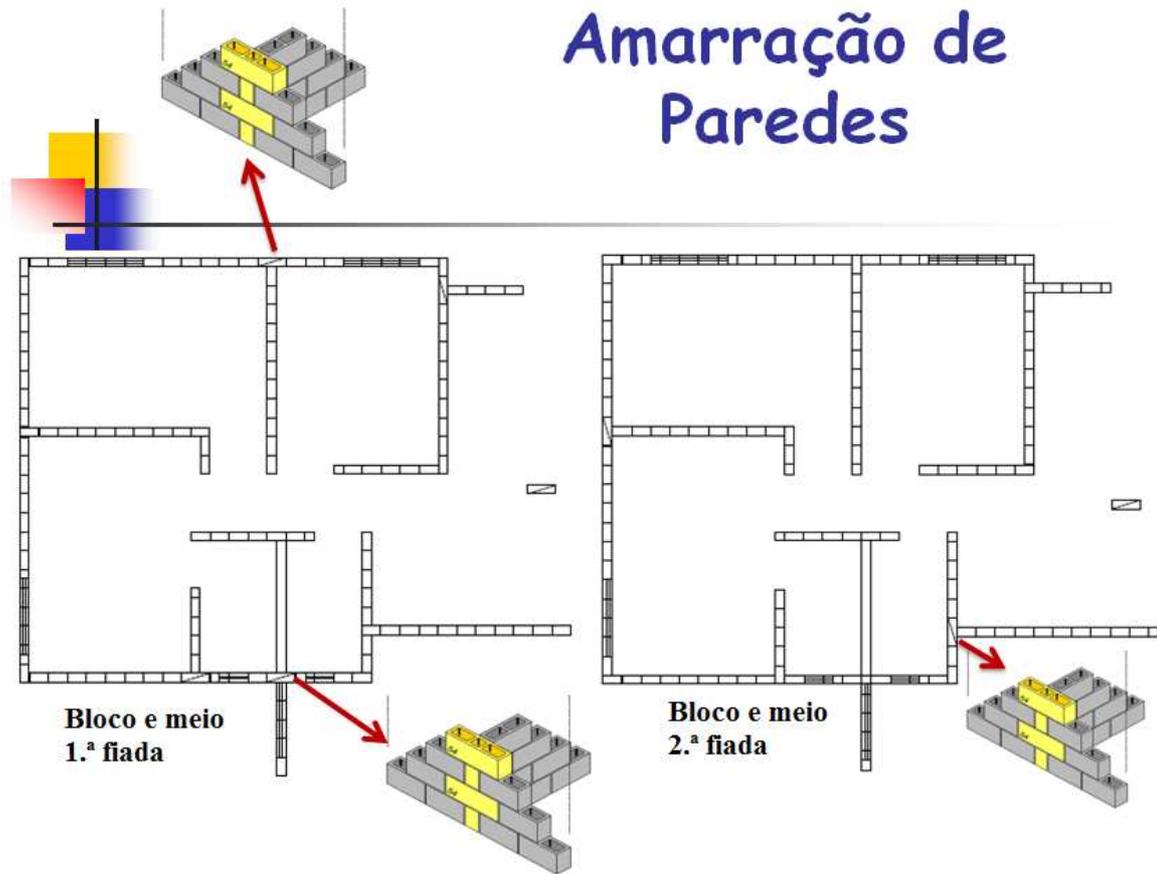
Modulação de um pavimento com amarração interna
